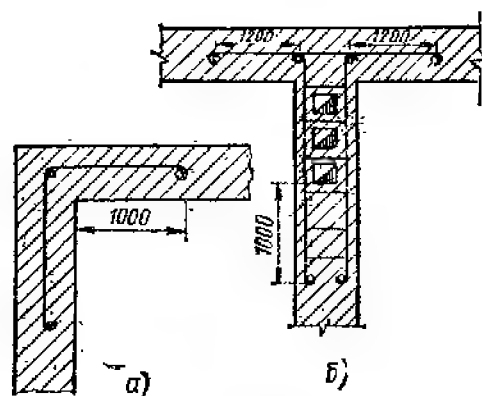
Армирование угла и примыкания внутренней стены к наружной:
